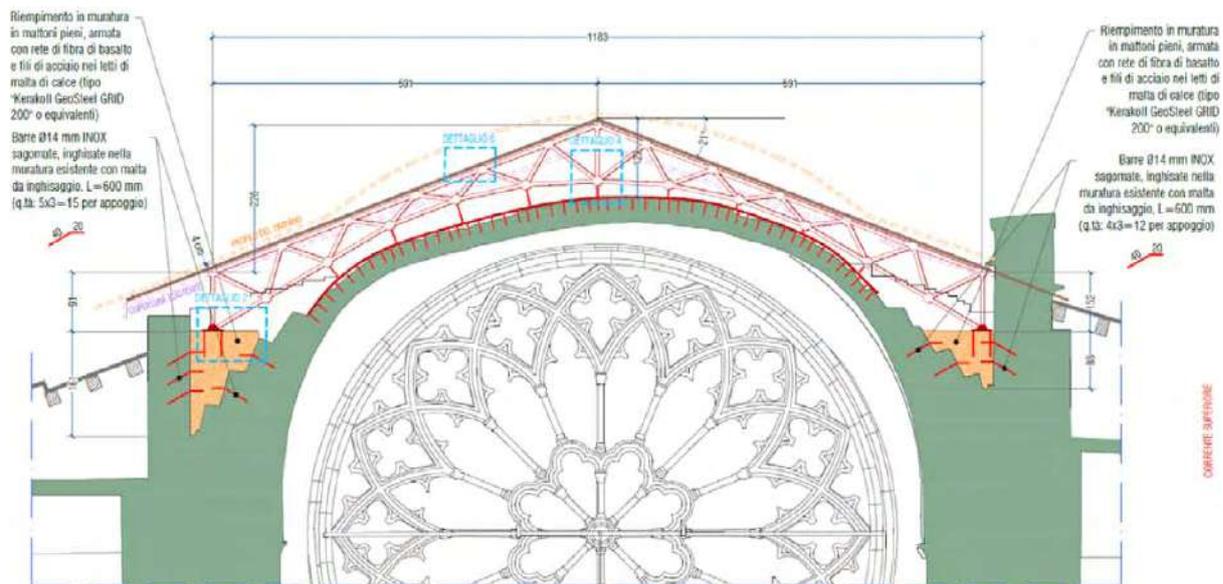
Sezione della volta con il telaio reticolare di consolidamento e rafforzamento.
